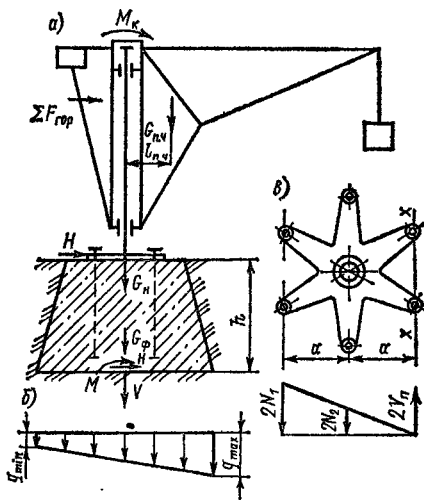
Расчетные схемы фундамента (а) с эпюрой давления на грунт (б) и фундаментной плиты (в)
